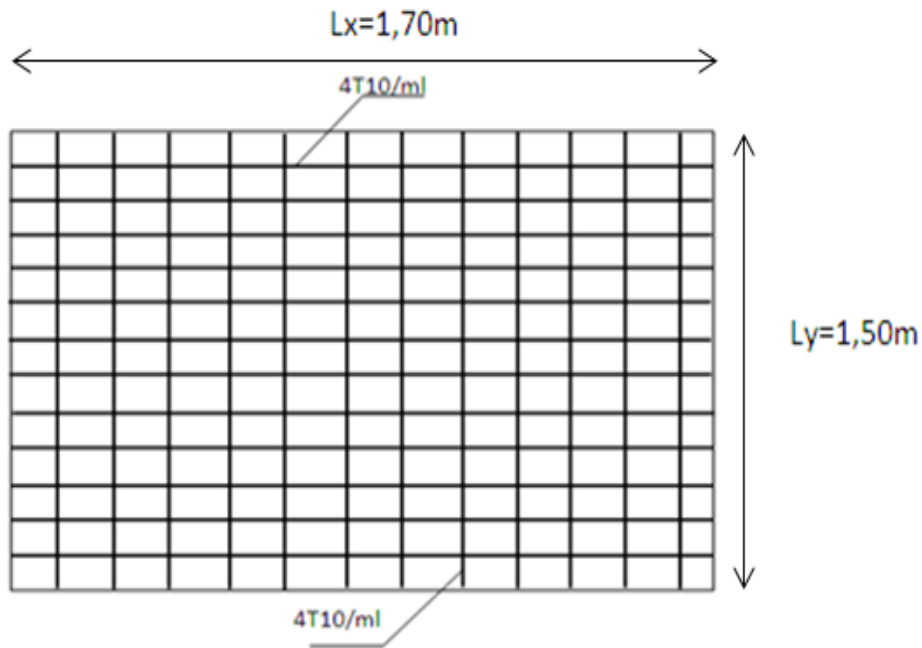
Ferrailage inférieur de la dalle de l'ascenseur.
